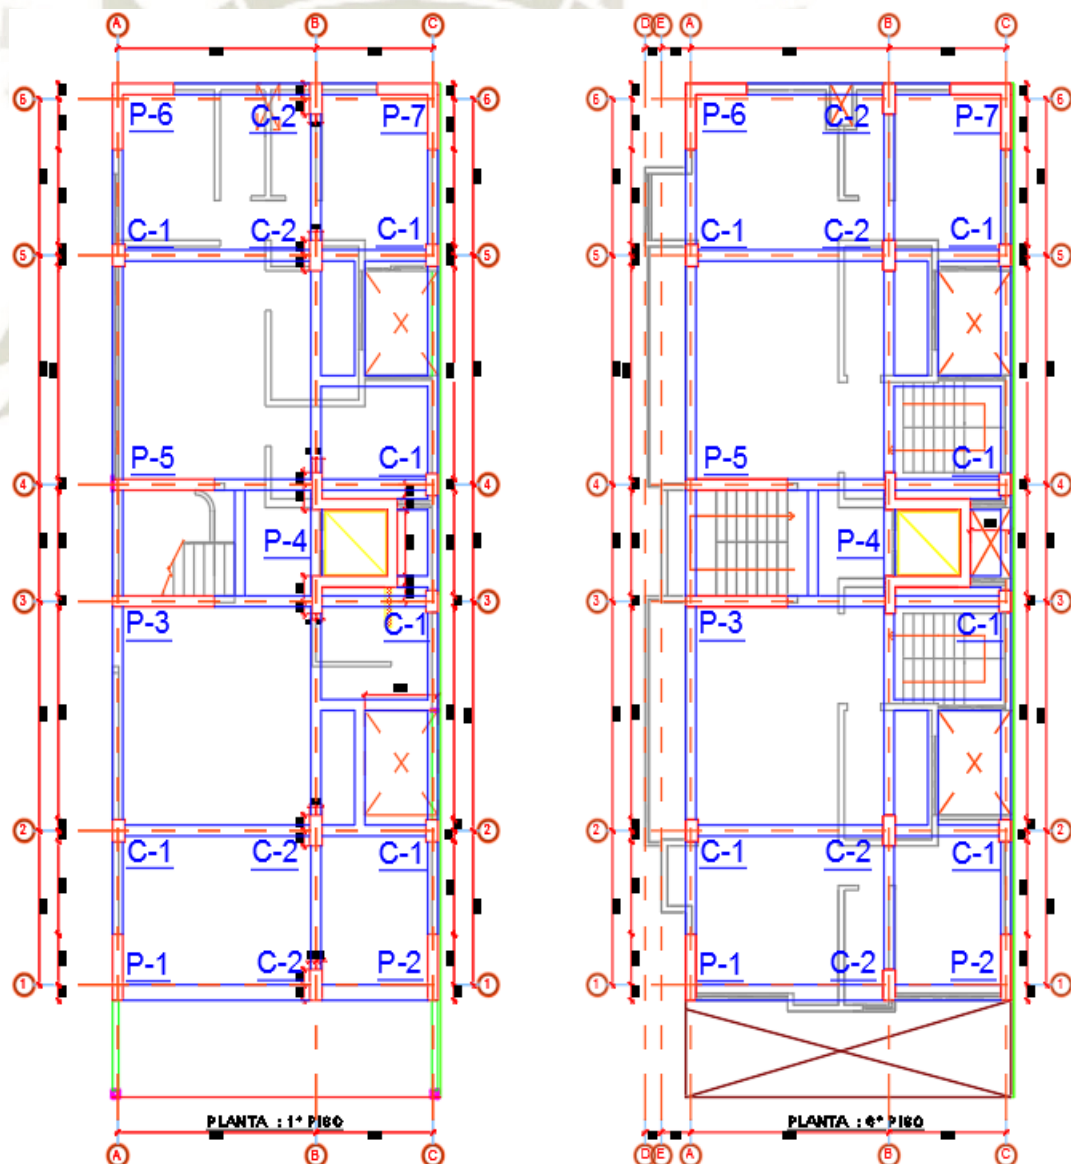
Tercera Estructuración de multifamiliar (Elaboración propia)
